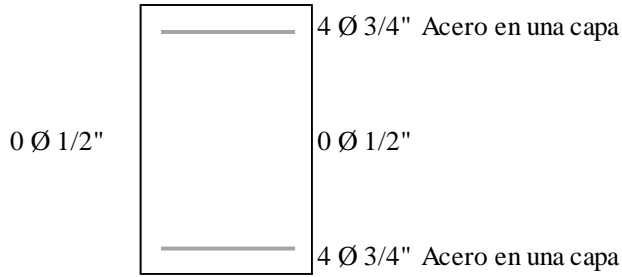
Distribución del Acero longitudinal de VP-203 (30 x 60) - Sistema estructural tradicional.
